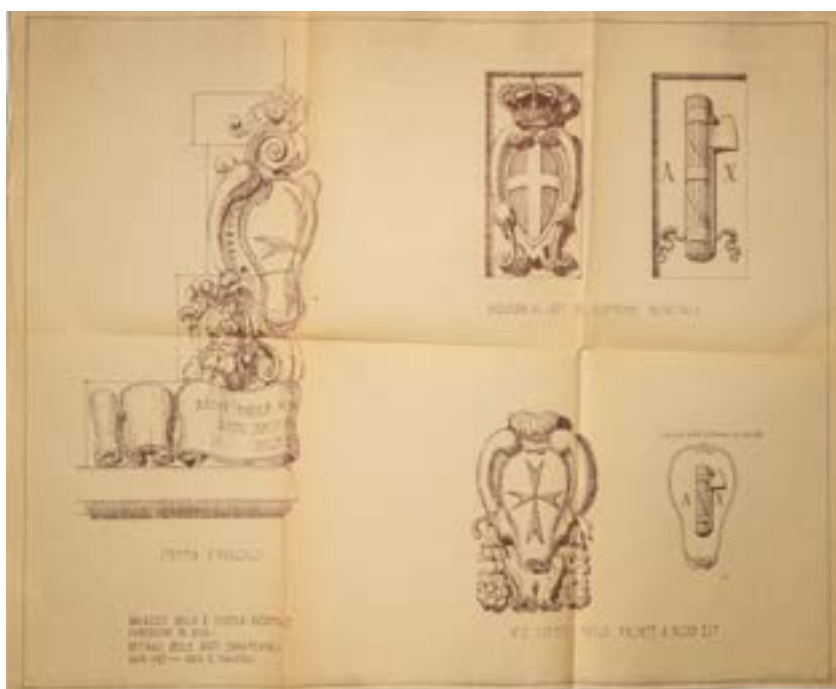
La facciata del Palazzo della Carovana con gli stemmi del regime. Pisa, Archivio Fotografico Fondazione Palazzo Blu, Fondo Allegrini, FALR7N103 - Proprietà della Fondazione Pisa/ Palazzo Blu.
